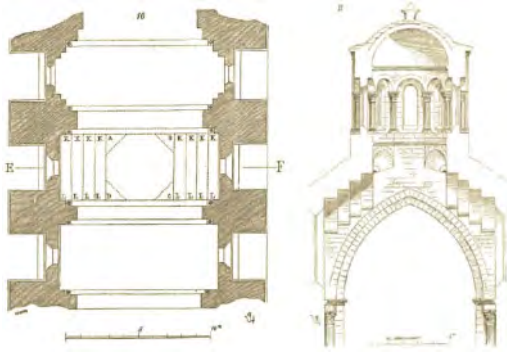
Notre-Dame-des-Dons ad Avignon, plan view and cross-section drawn by Viollet-le-Duc (1859).
